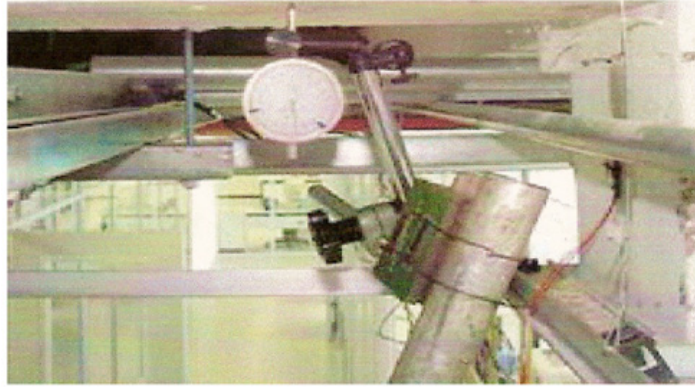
Instrumentação do pilar (recalque da fundação)
